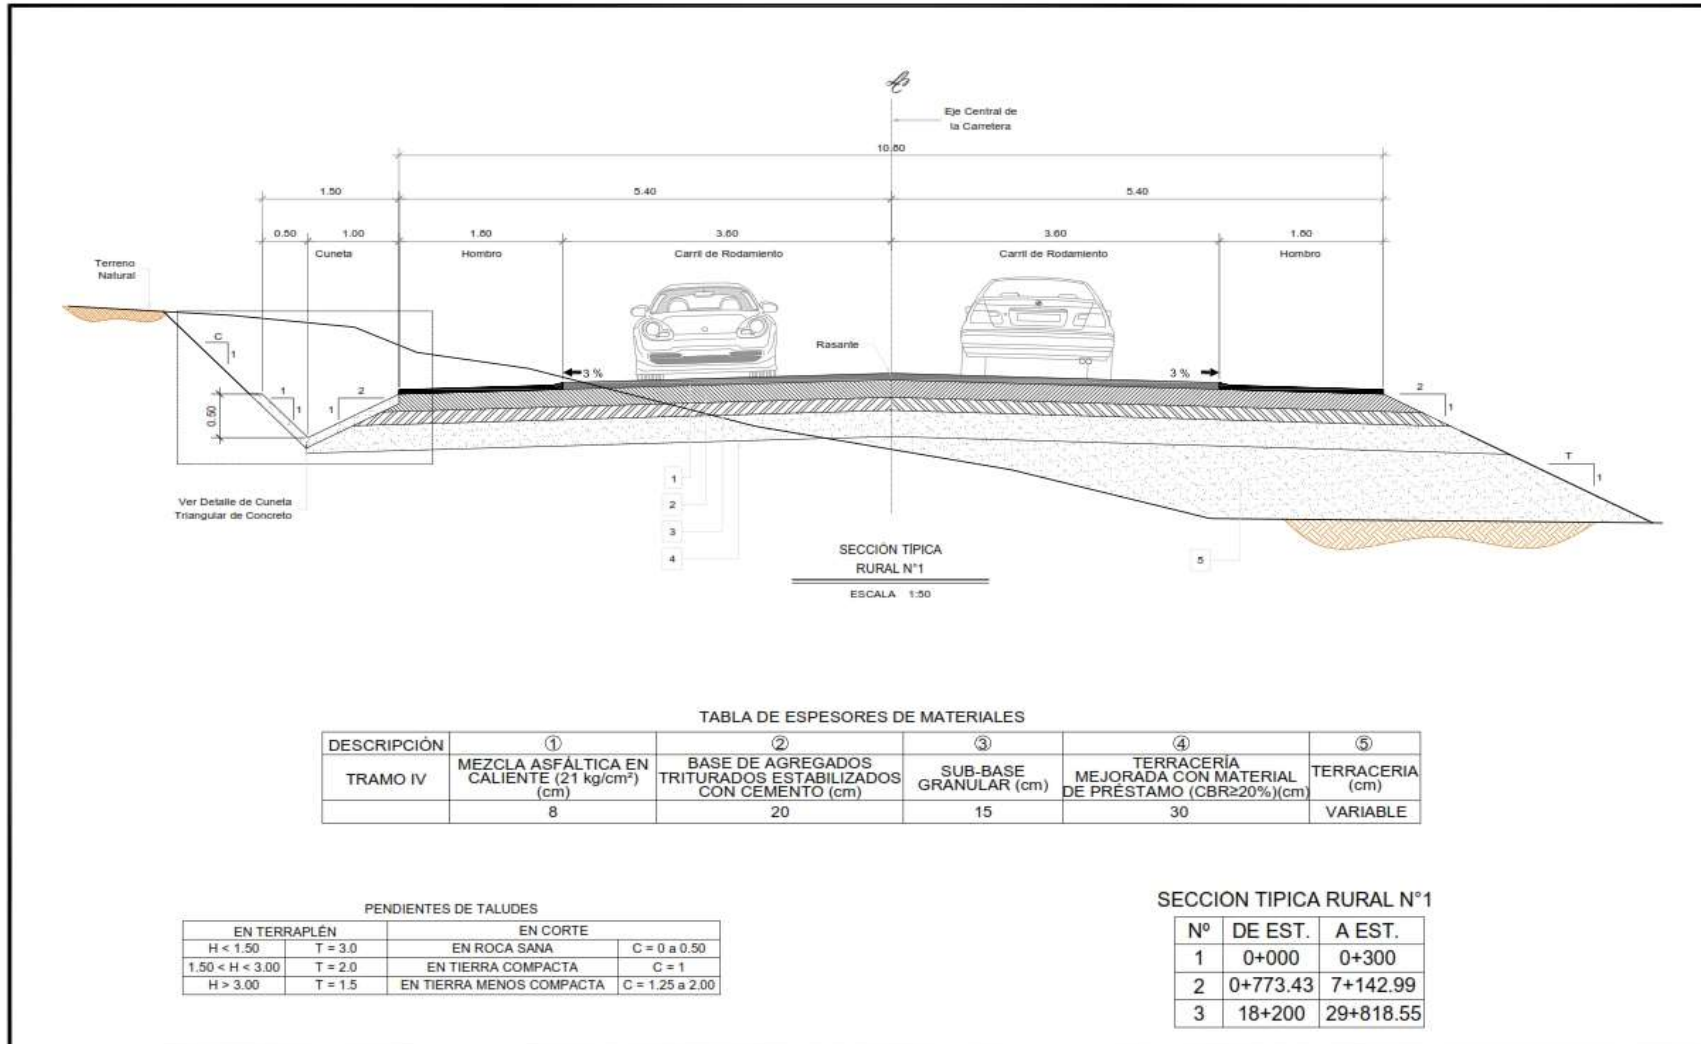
Propuesta de Sección Típica Transversal Zona Rural N°1
